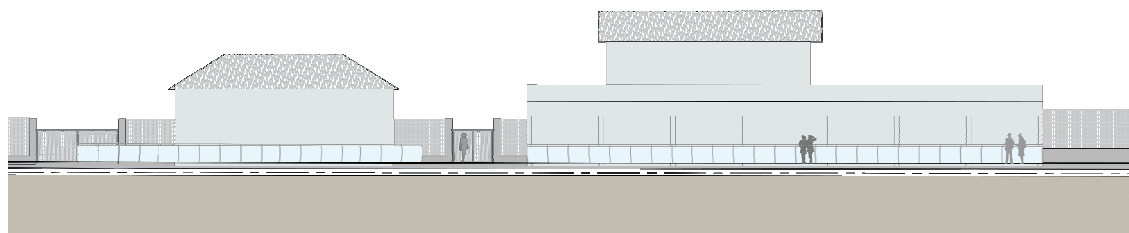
Prospetto Fabbricato viaggiatori esistente a seguito dell'innalzamento
